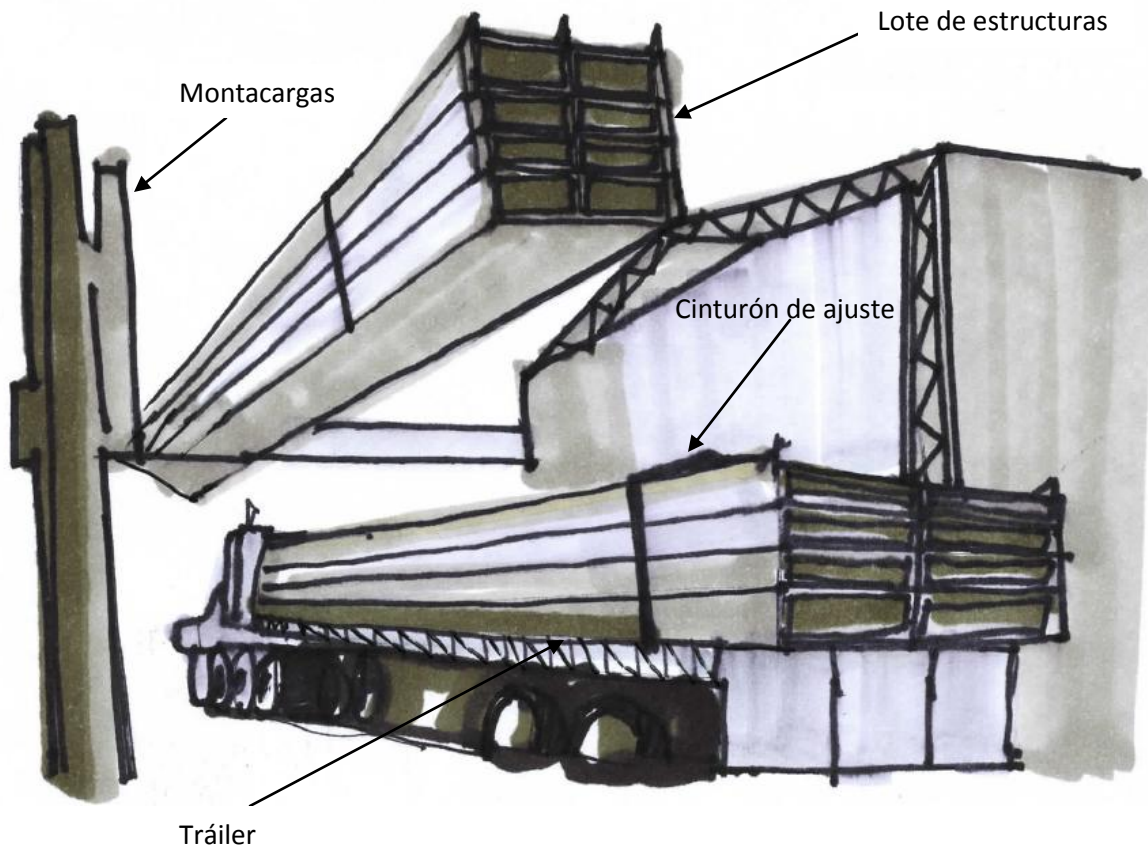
Maniobras de transporte de Estructuras Metálicas de la fundidora a la obra.
